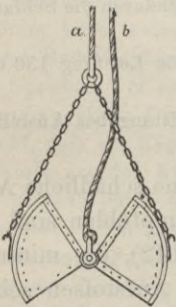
bis 140. *Betonkasten von den Kieler Bauten.*Abb. 141 bis 143. *Betonkasten vom Bau der Harburger Elbbrücke.
